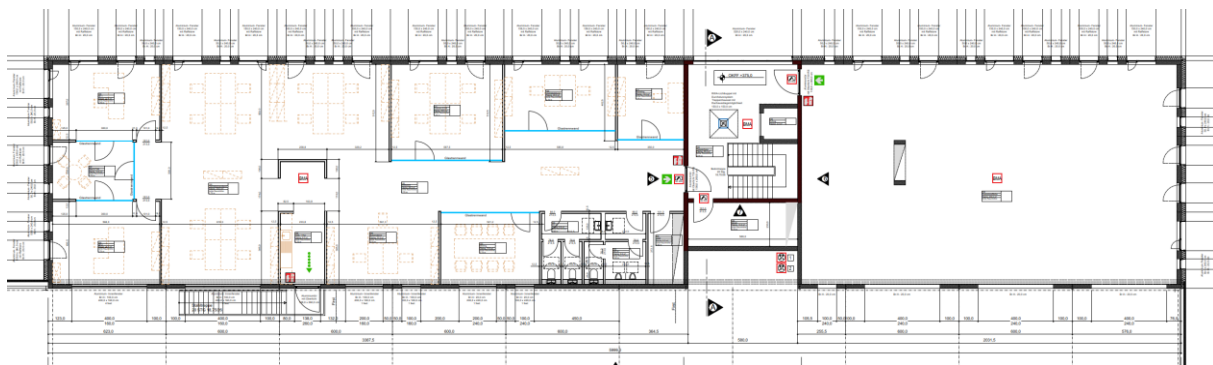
Grundriss Obergeschoss – Verwaltung
